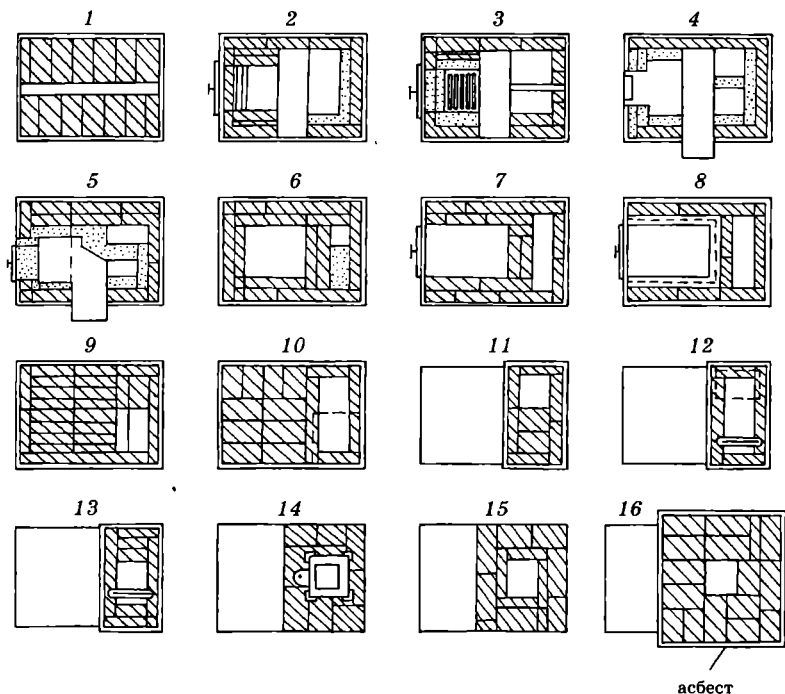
Порядовка кладки печи А. Ф. Филичко
